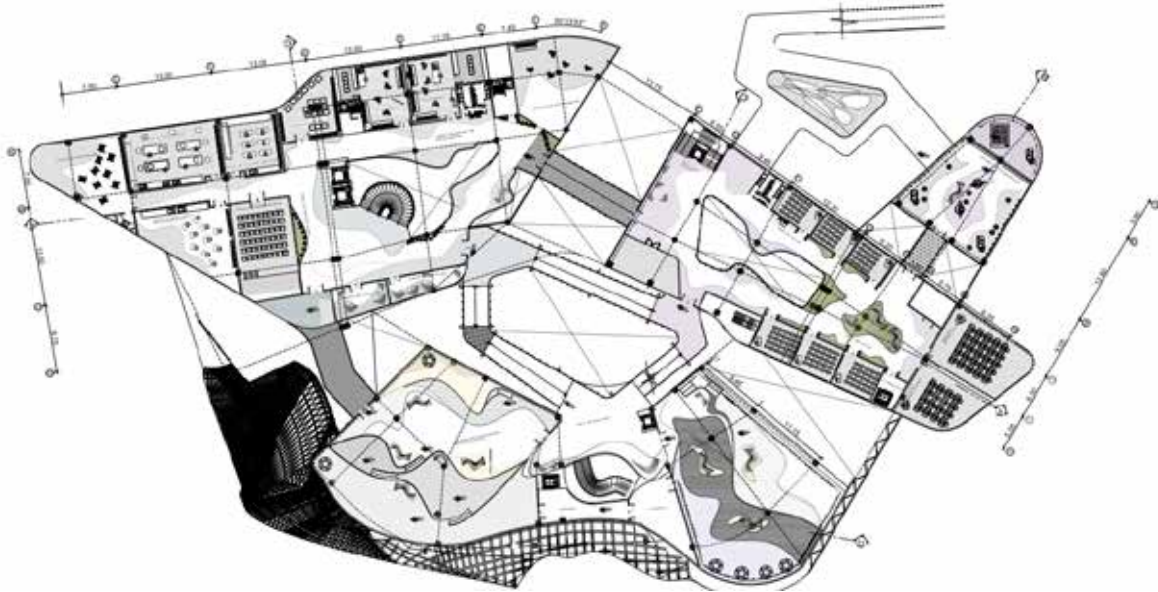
Plano Planta primer piso de escuela de artes. (2017)
